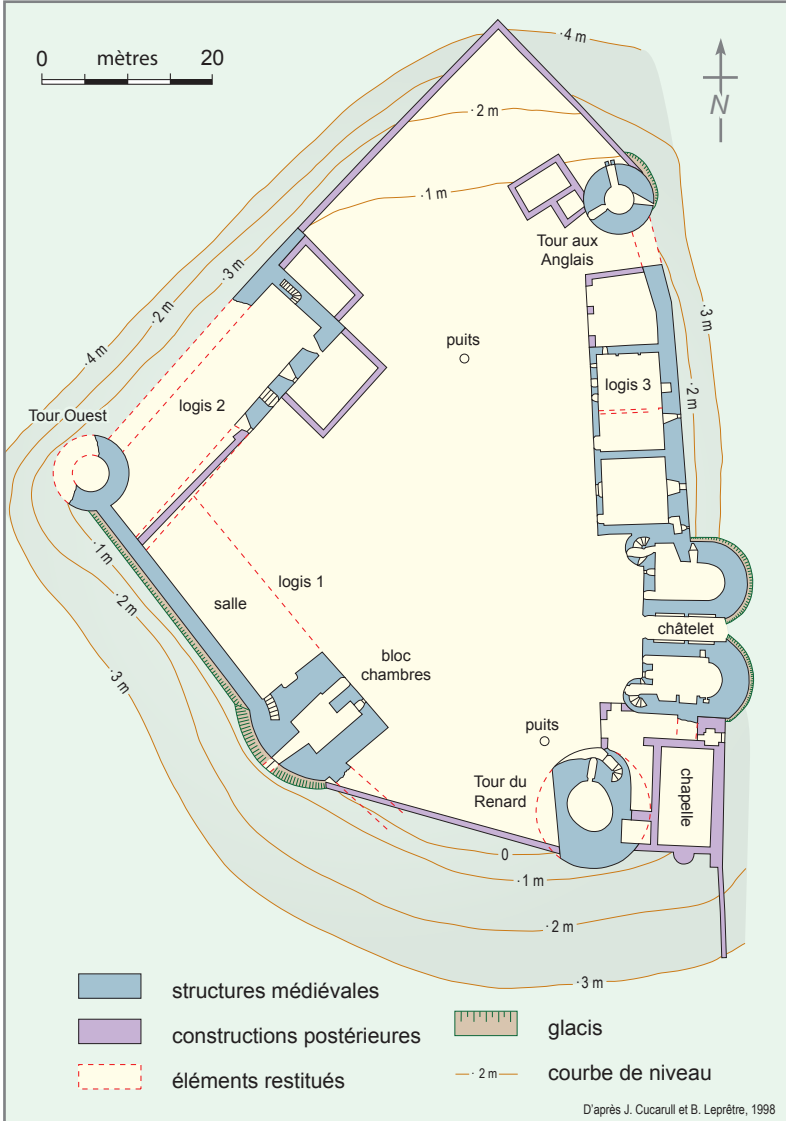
Plan du château (dessin D. Shewan d’après les relevés de J. Cucarull et B. Leprêtre, 1998)
